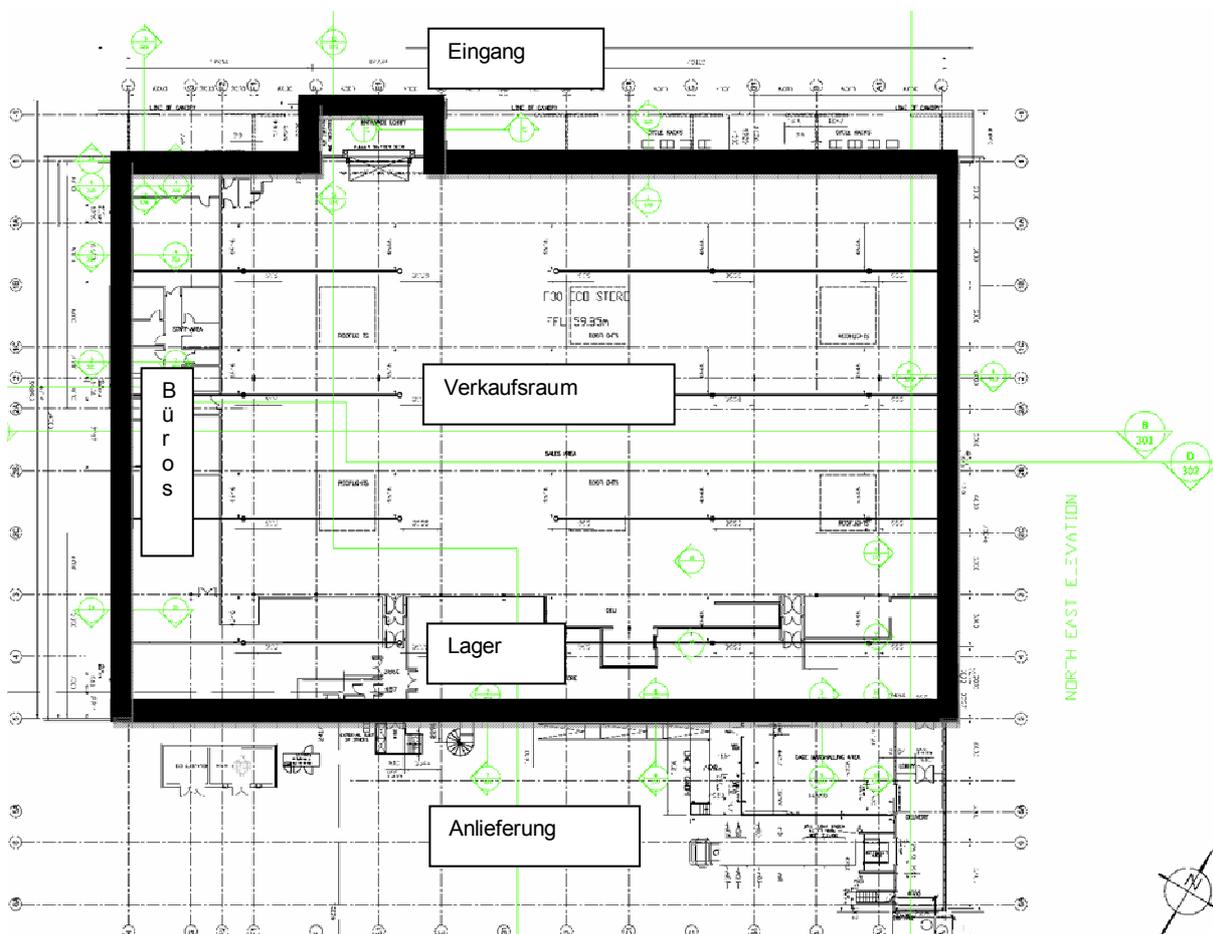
Grundriss: Die Energiebezugsfläche umfasst Eingangs-Lobby, Verkaufsfläche, Büros und Lager - Tesco Tramore. Zeichnung: Joseph Doyle Architects, Dublin, Irland
